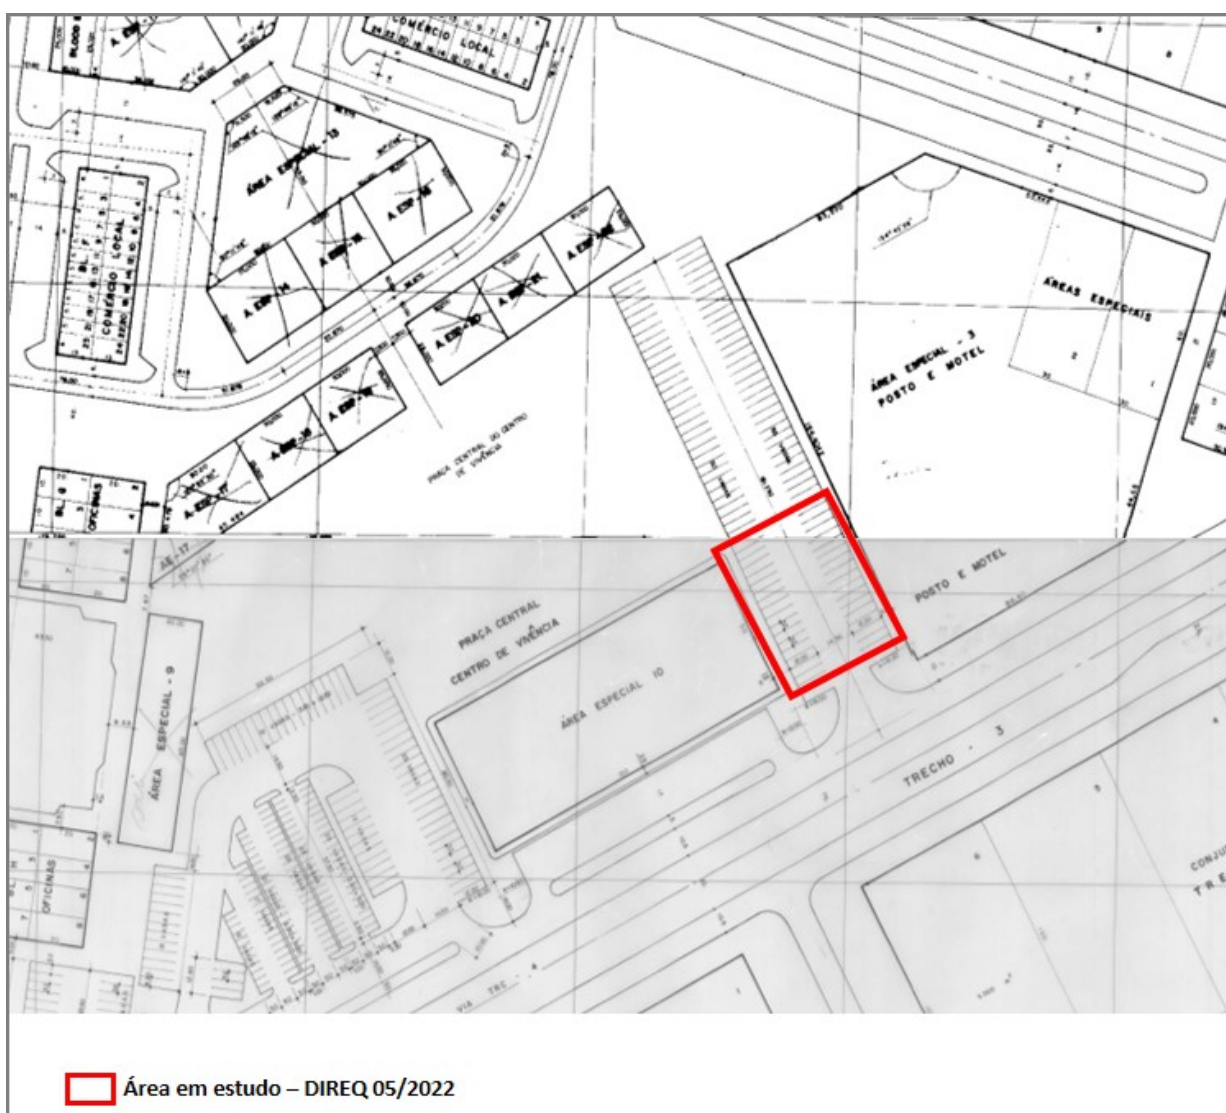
Recorte da STRC URB 29/1985, com indicação da área em estudo
